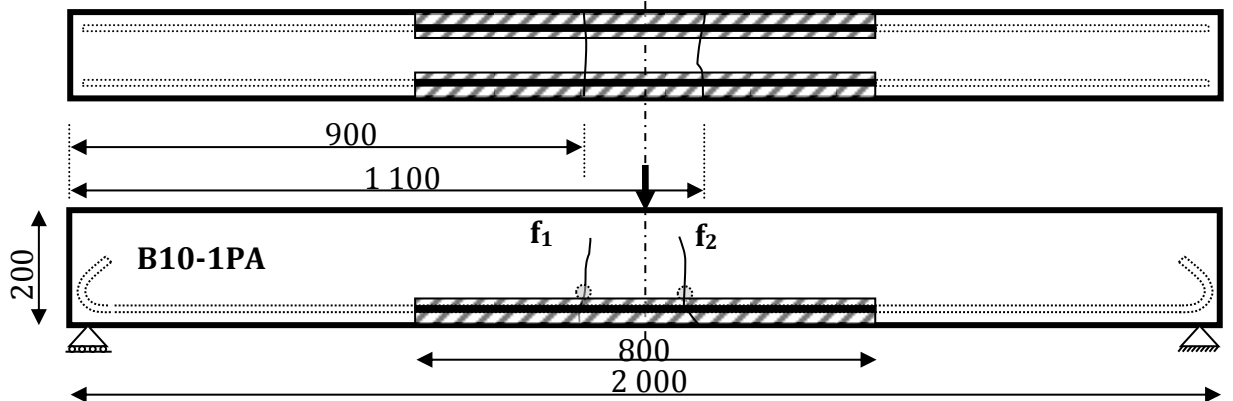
Cartes des fissurations de la poutre B10-1PA au niveau de pré-chargement de 13.5 kN.m.
